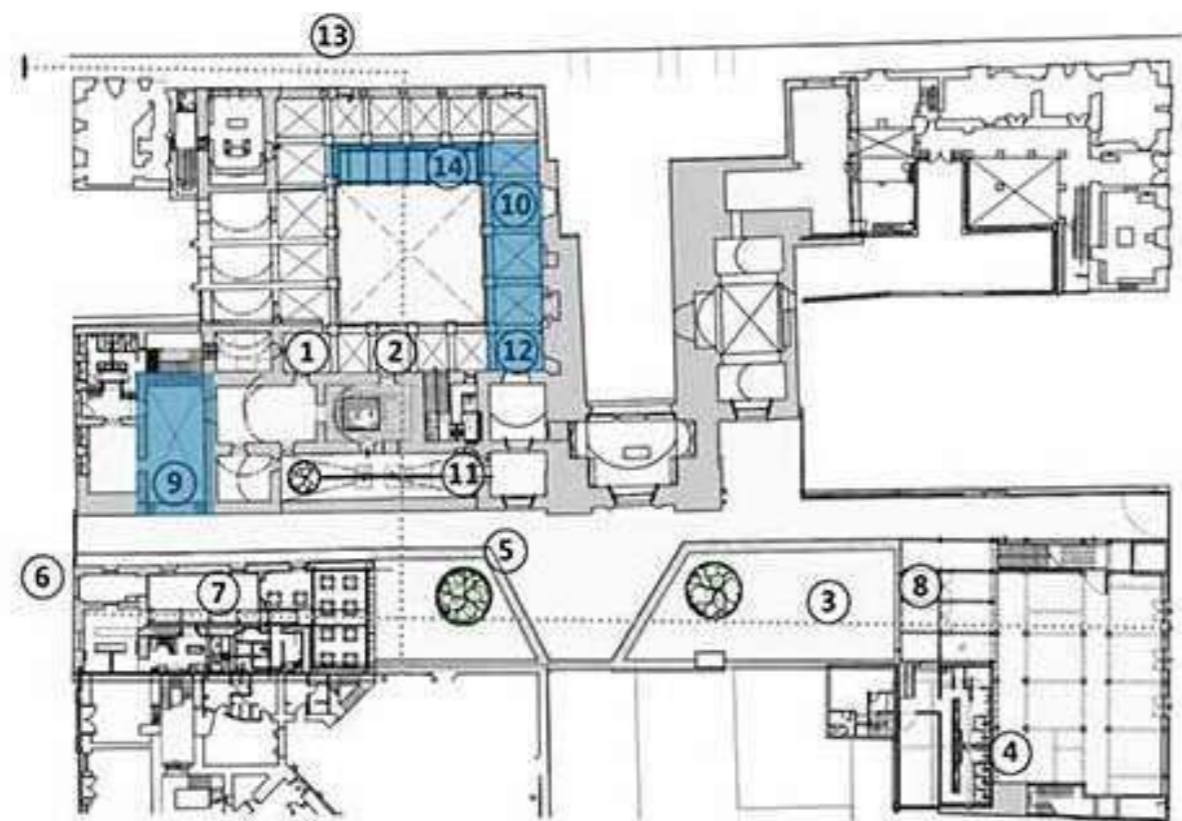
Planta arquitectónica de intervención. Elaboración propia.
